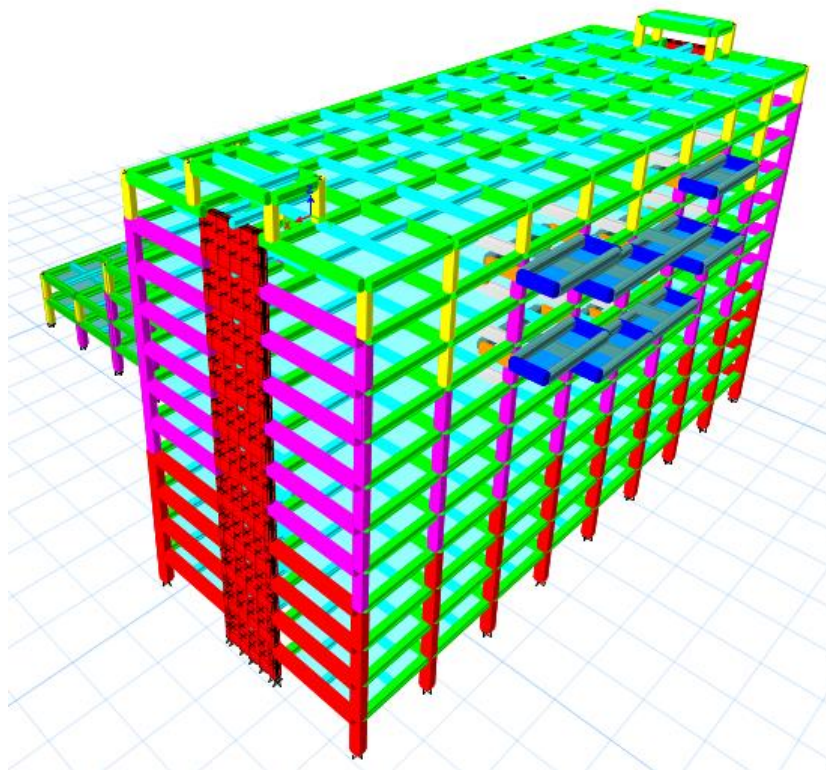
Tiga Dimensi Gedung Tampak Belakang Model 1
